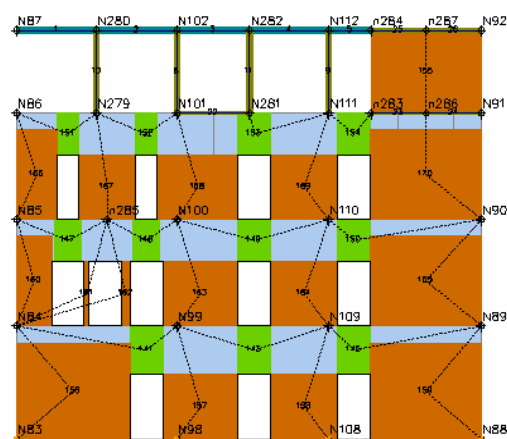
Schematizzazione a telaio equivalente della parete 15
